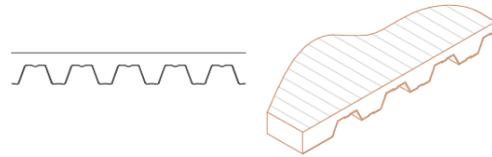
\_Esquema de sistemas estructurales por pieza.
